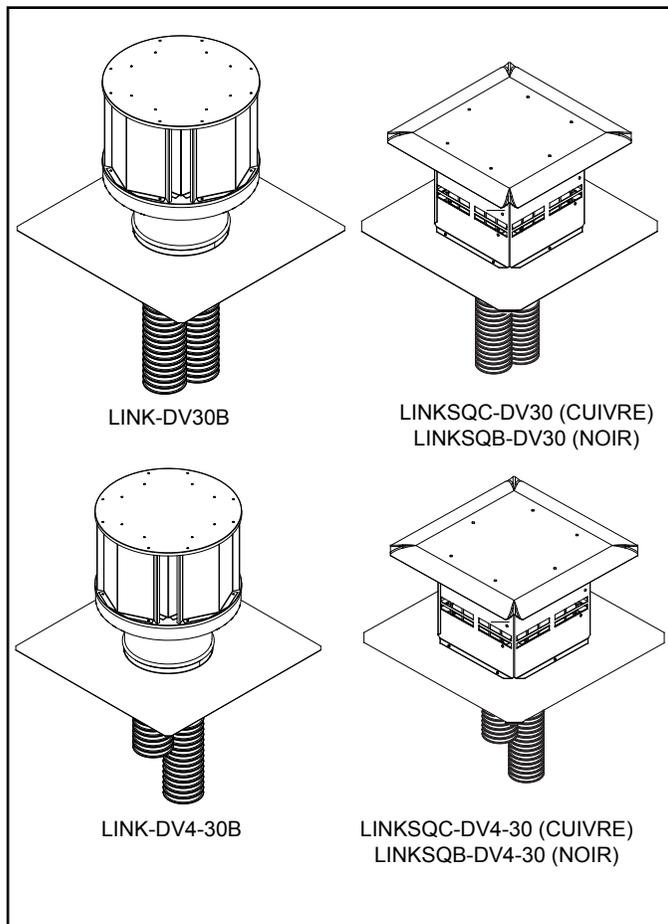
Ensembles de doublage de conduit flexible d'évacuation directe
